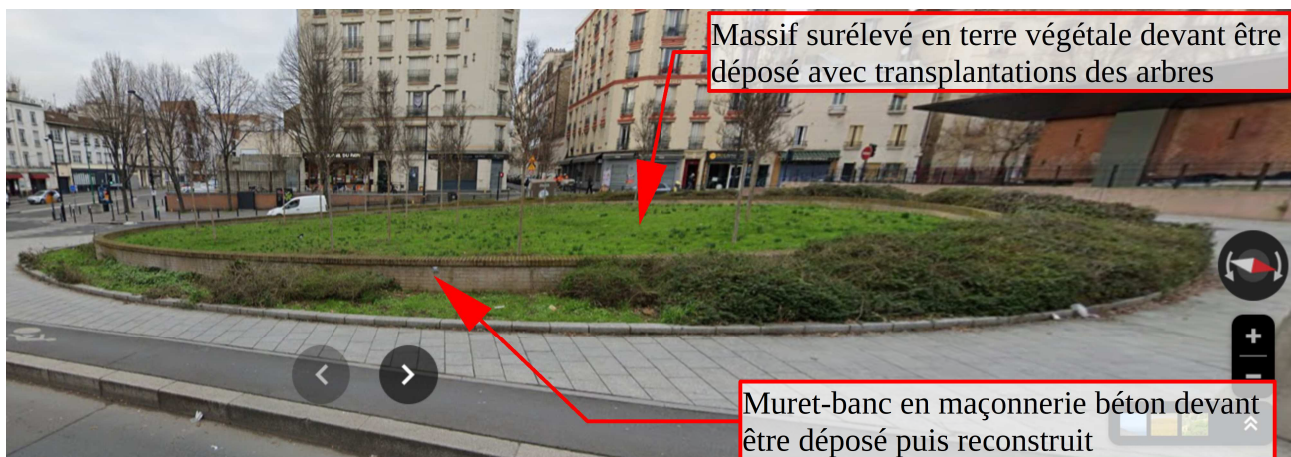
Muret-banc en maçonnerie béton planté d'arbres
